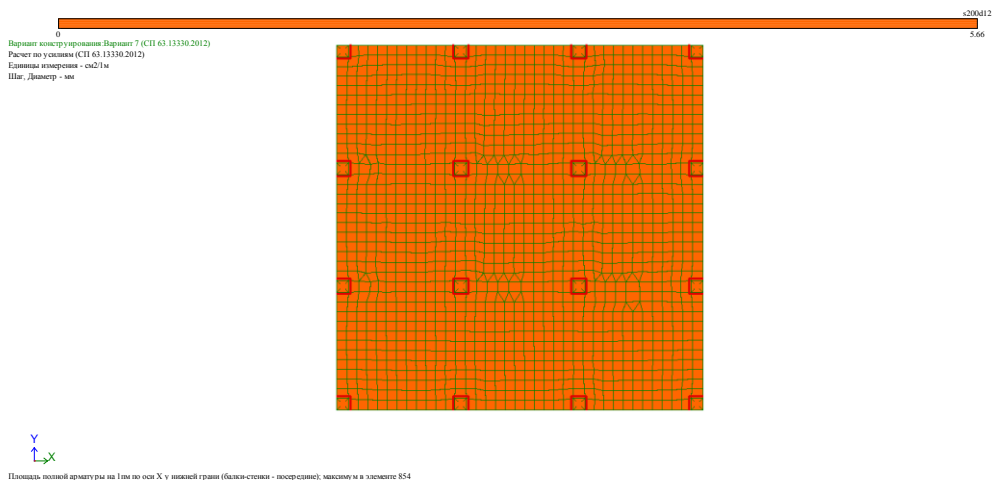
Подбор нижней продольной арматуры плиты
